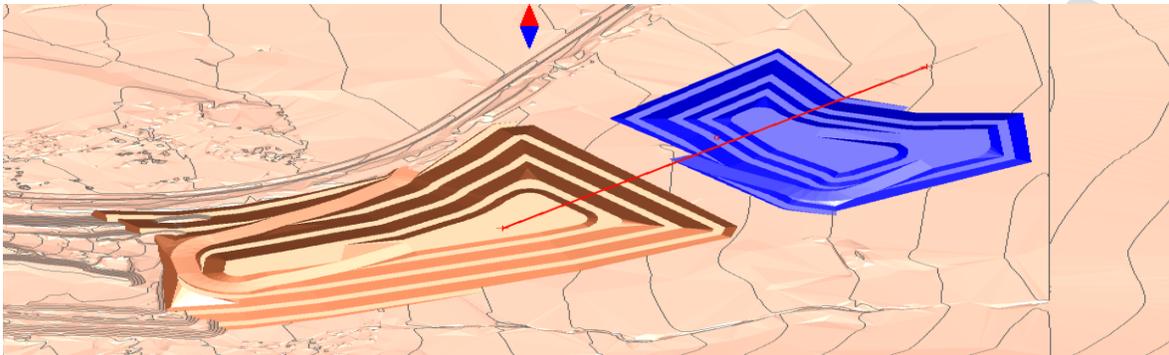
Vista en planta y corte longitudinal de Tepetatera Suroeste
